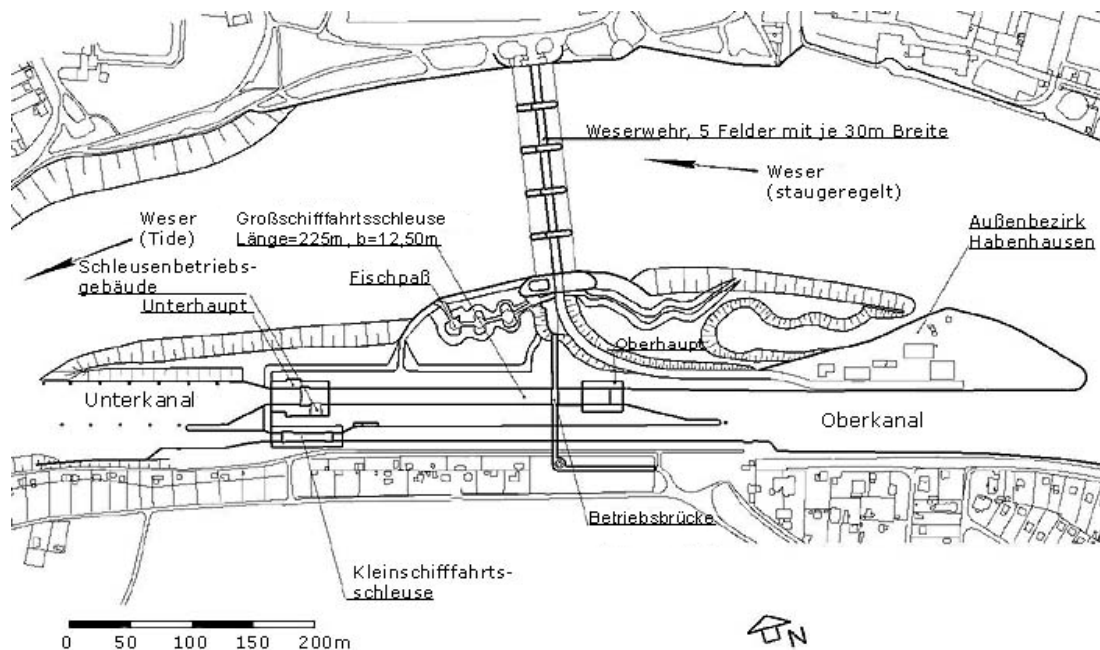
Lageplan Weserwehr Hemelingen (WSA BREMEN, 2006)
